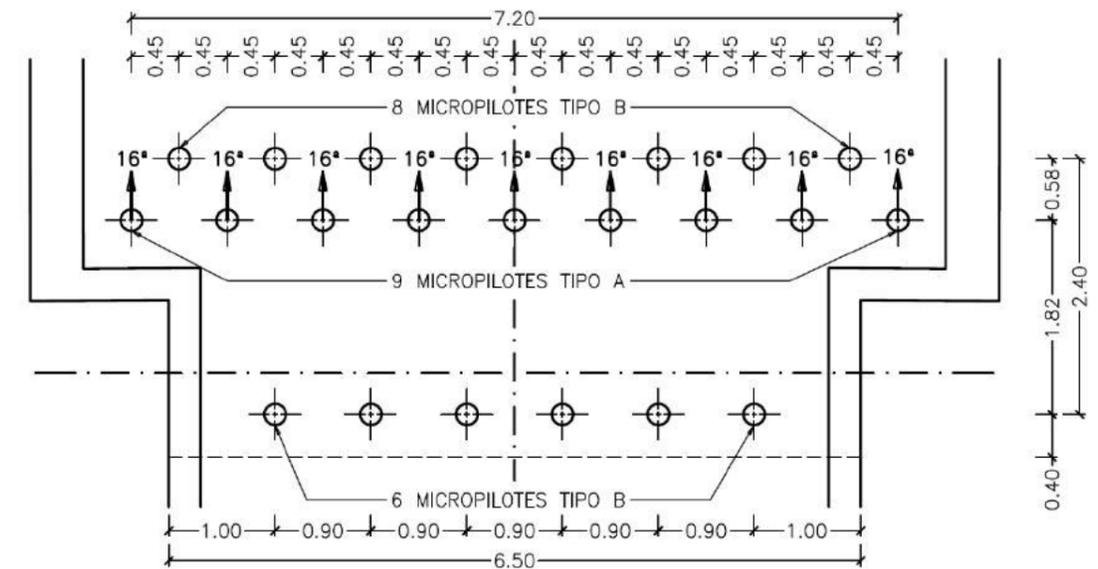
Disposición en planta en cabeza de los micropilotes del estribo 1
